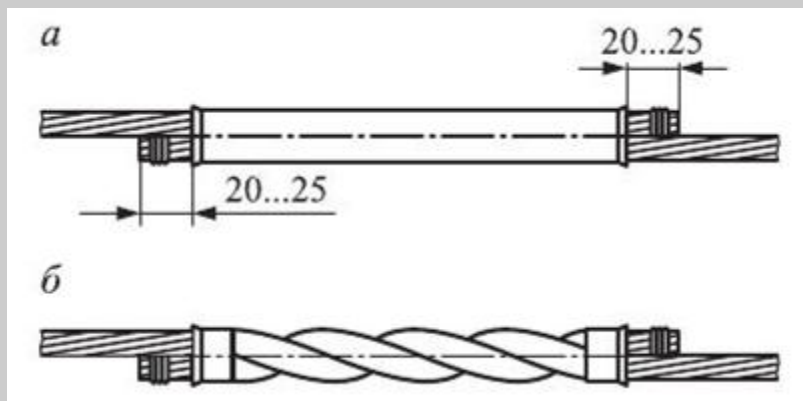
Схема соединения проводов скручиванием: а - подготовленный к скручиванию овальный соединитель; б - готовое контактное соединение (проводами) устанавливают в специальное приспособление и зажимают с обеих сторон. Далее, поворачивая один конец обжимки на 4-4,5 оборота с зажатом в ней соединителем, производят скрутку соединителя. Готовое соединение, свободно проходящее через раскатанные ролики, показано на рис. 5.6, б. Монтаж соединения могут выполнить на земле один-два человека.
